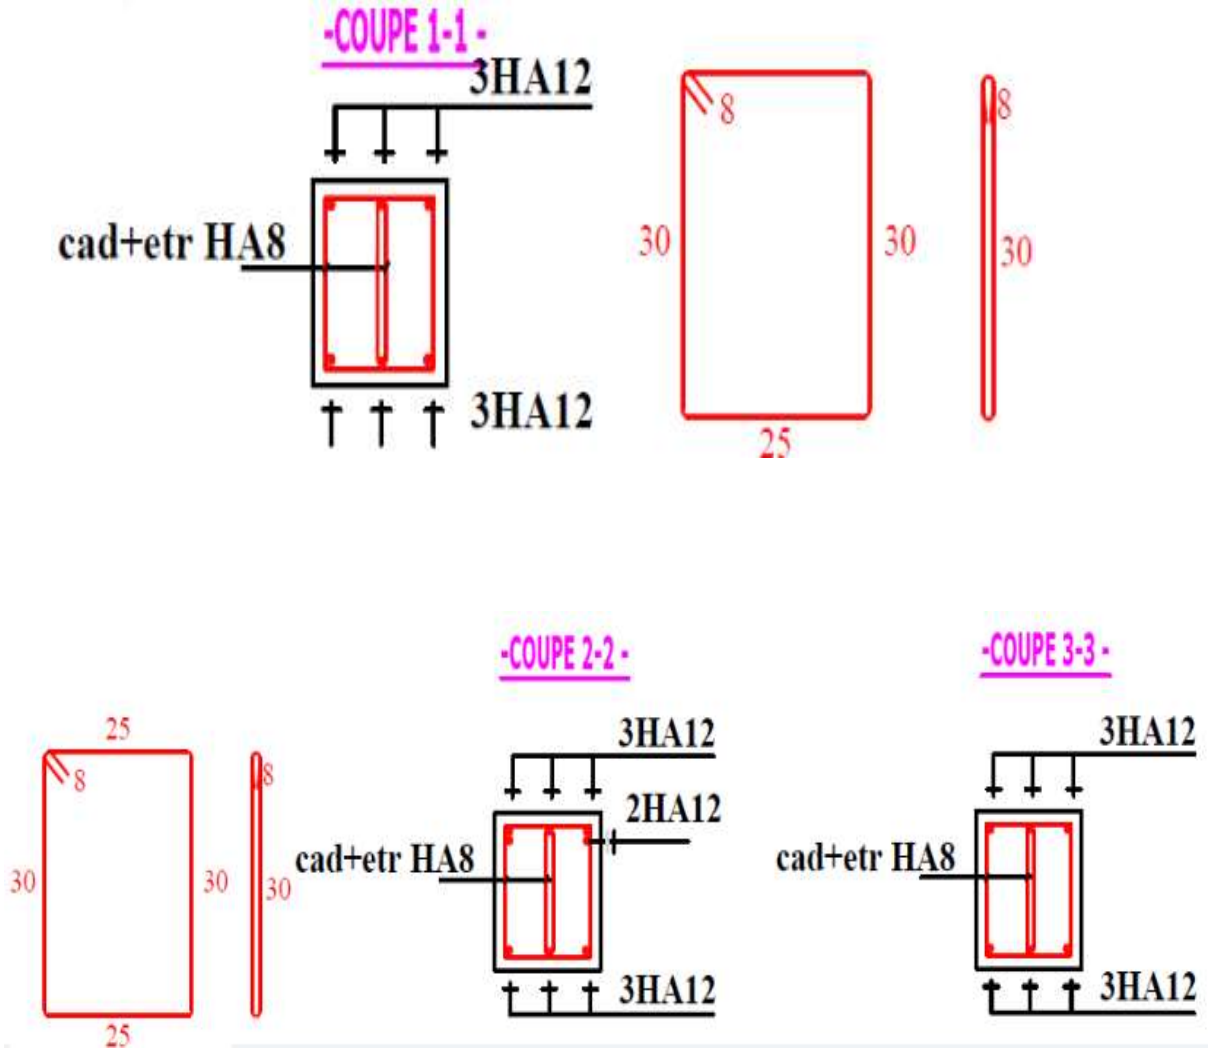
Coupes transversales de la poutre secondaire (30x35)
